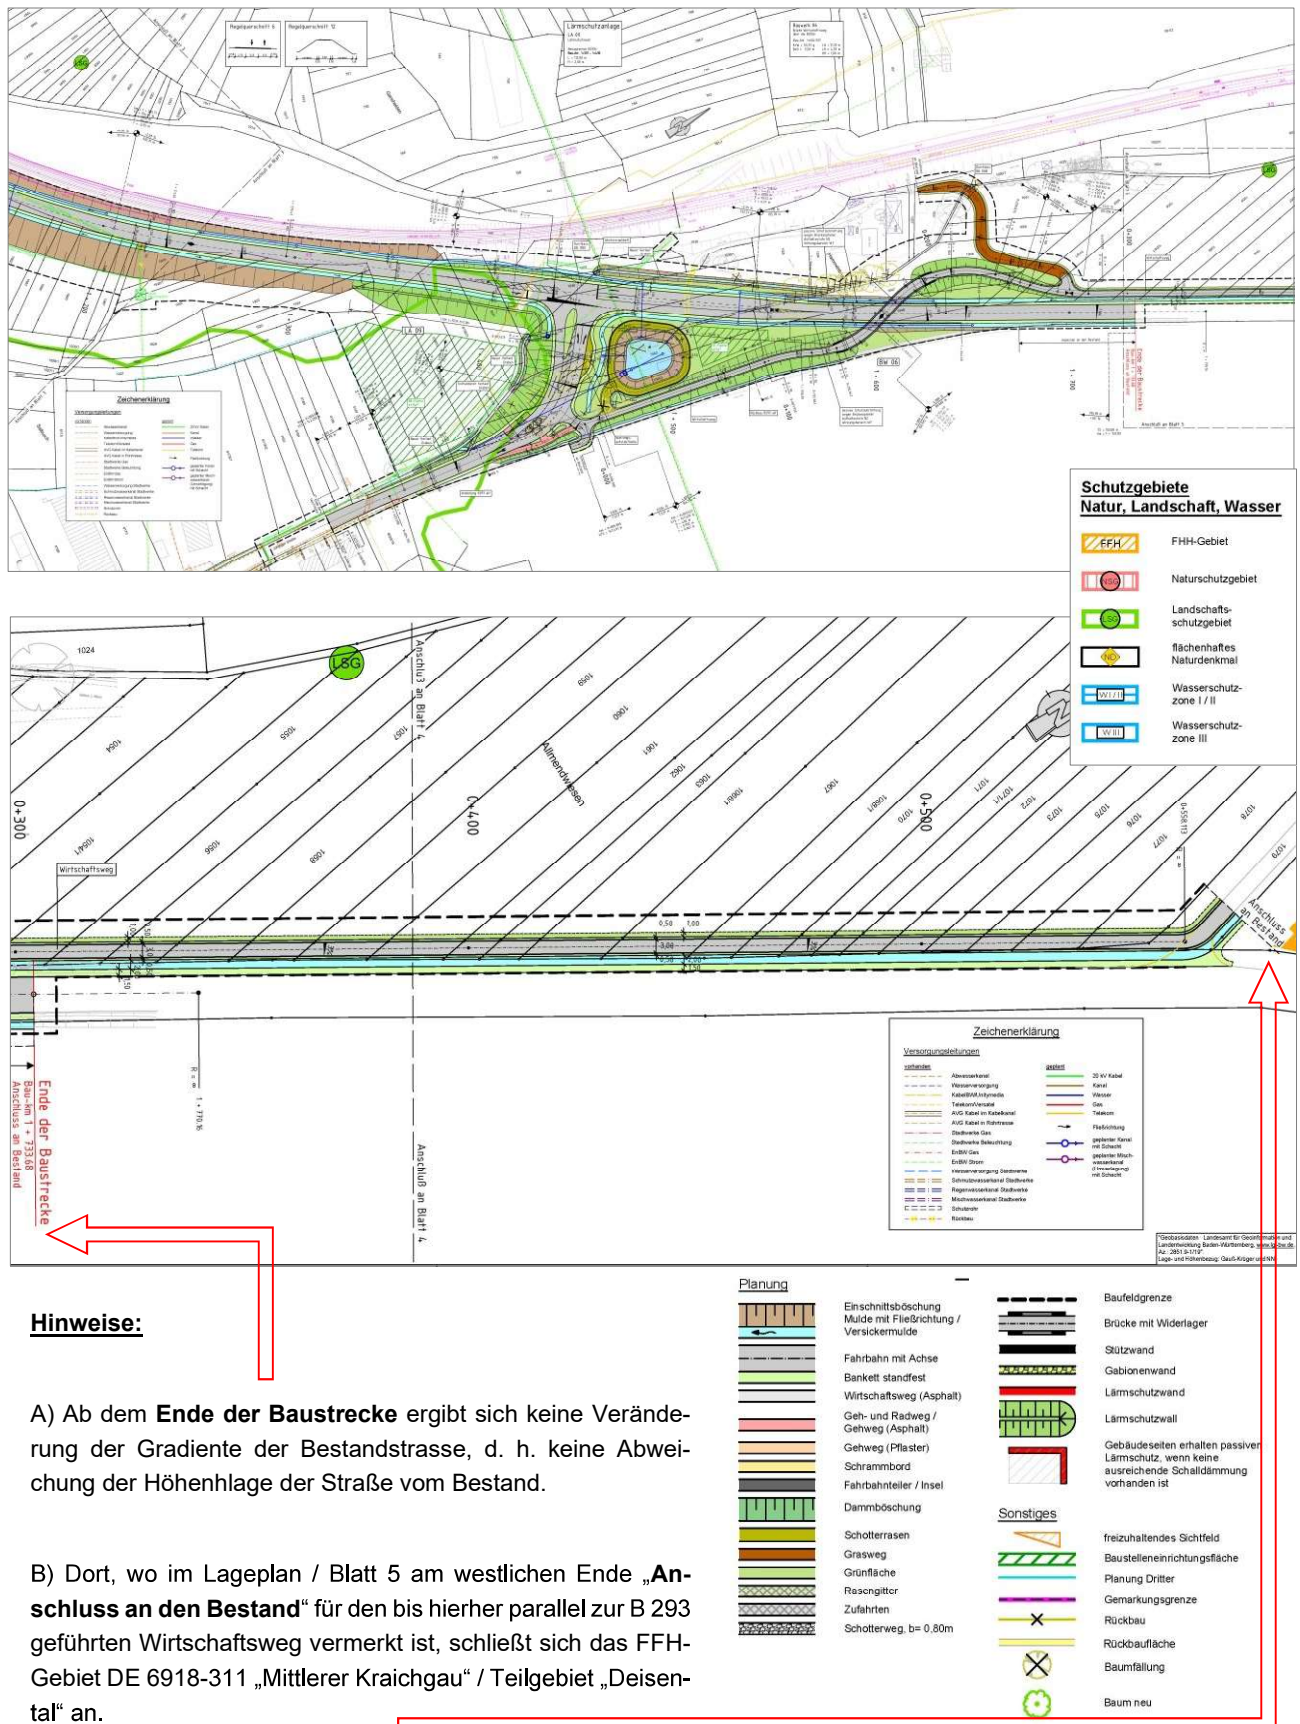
Lageplan / Blatt Nr. 4 (oben) und Lageplan Blatt Nr. 5 (unten) zum Feststellungsentwurf (M. 1:1.000)
